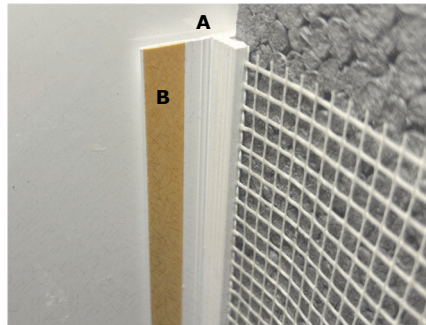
Perfil de ventana adherido a la carpintería (A) y con malla para refuerzo de la mocheta de hueco. Fuente: M. Epelde.
